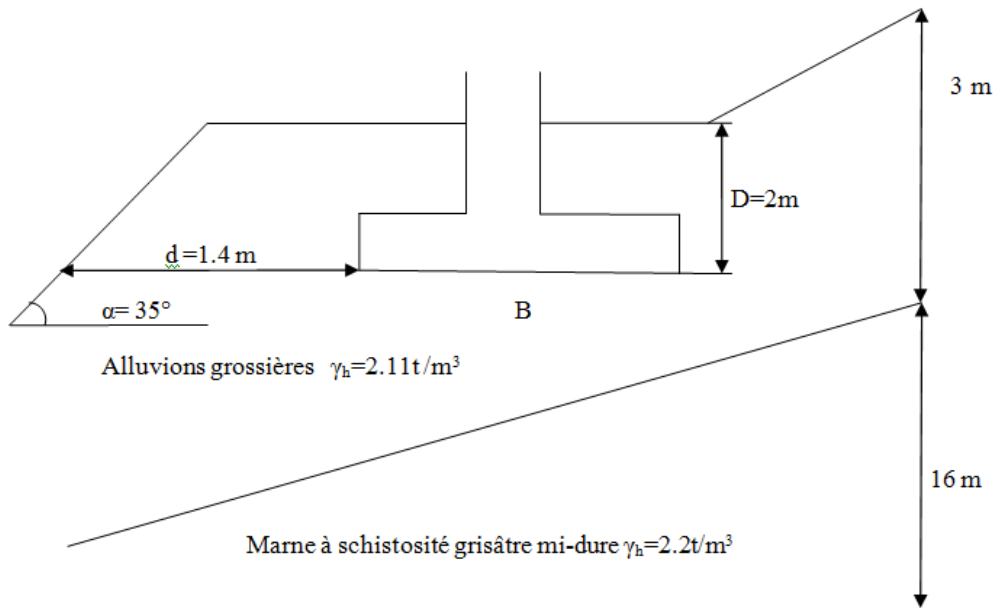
coupe sur le sol sous la fondation (SP3).
